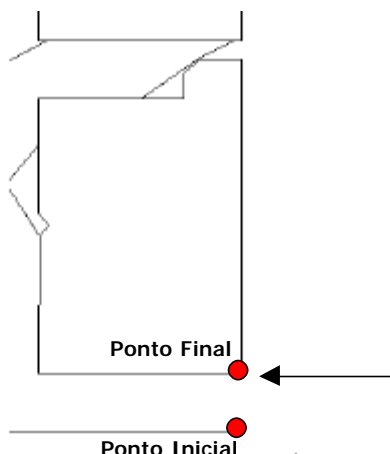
Pontos inicial e final para desenho do primeiro muro.
